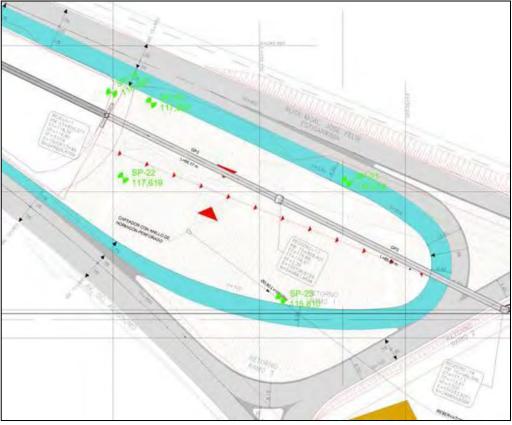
RETORNO DE CALZADA - SAN LORENZO
